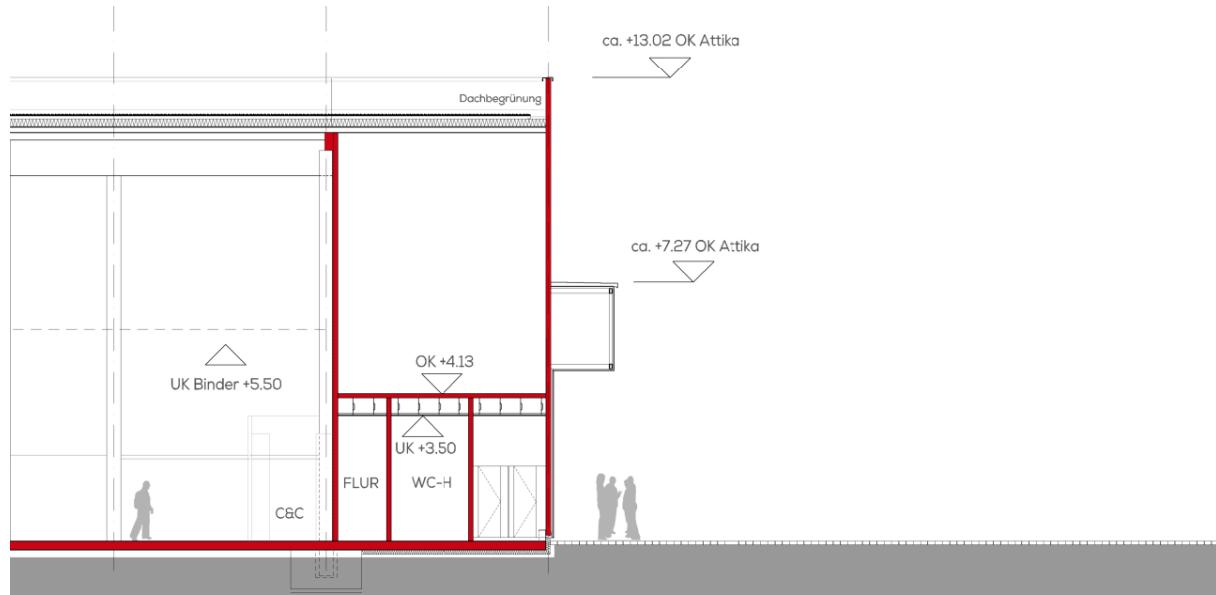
Ansicht Systemschnitt zur Veranschaulichung der geplanten Gebäudehöhe
